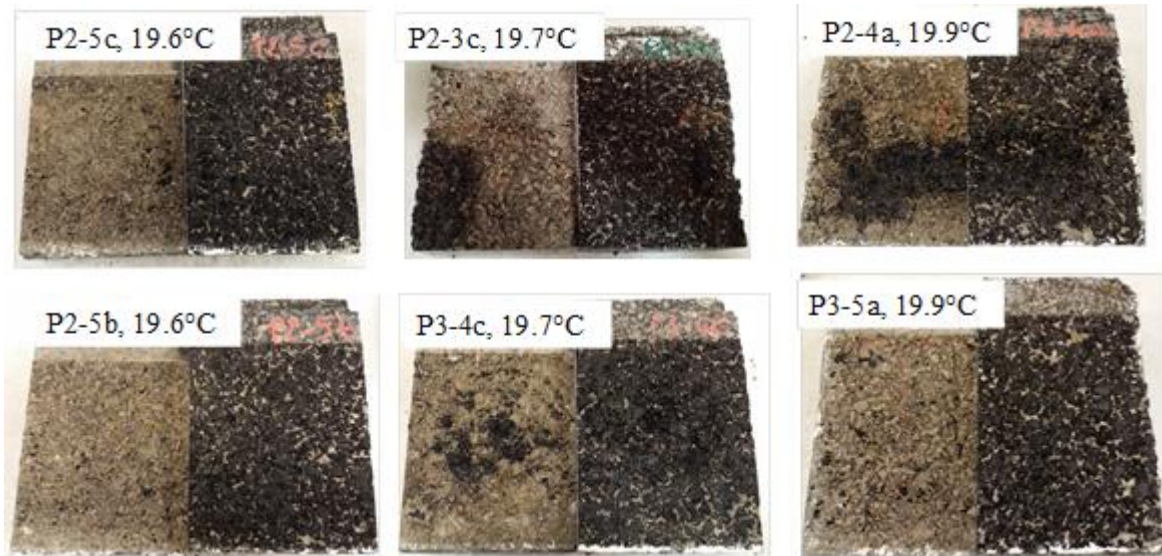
Surface de rupture pour les éprouvettes B/N testées sous eau à 20°C (2mm/min)
